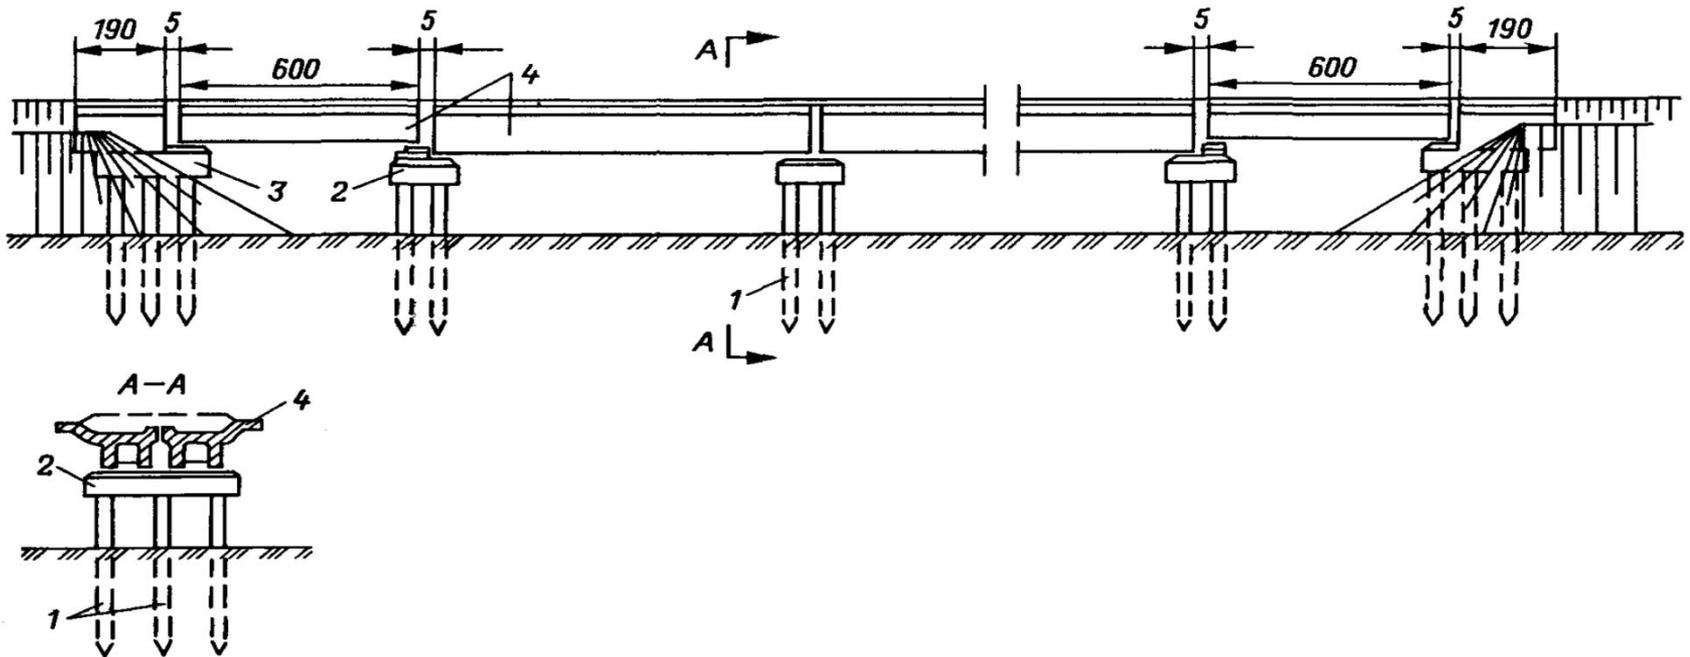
Схема сборного железобетонного моста эстакадного типа на свайном основании
